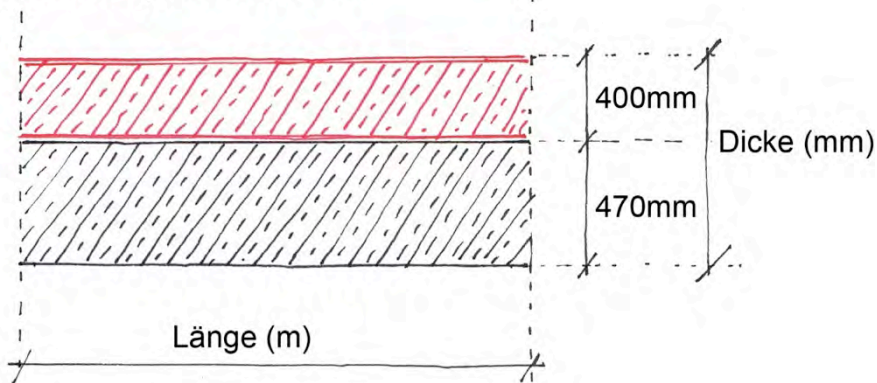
Parallele Wand, Bestand und Neu Stahlbeton
